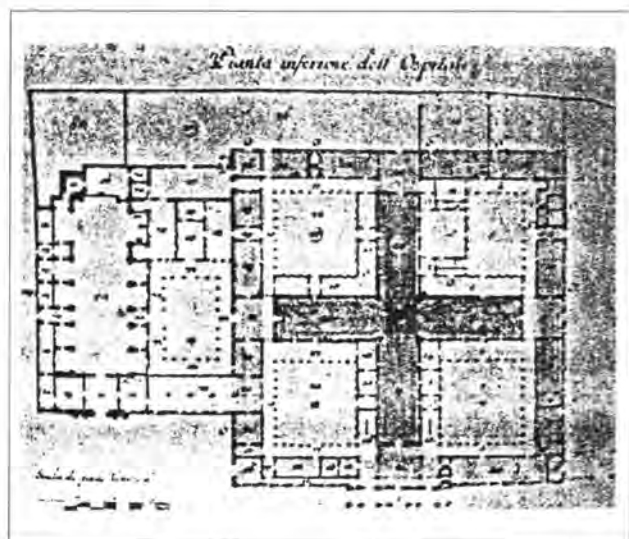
Udine, progetto dell'Ospedale del 1781: pianta (da CASTELLI, 1942).
